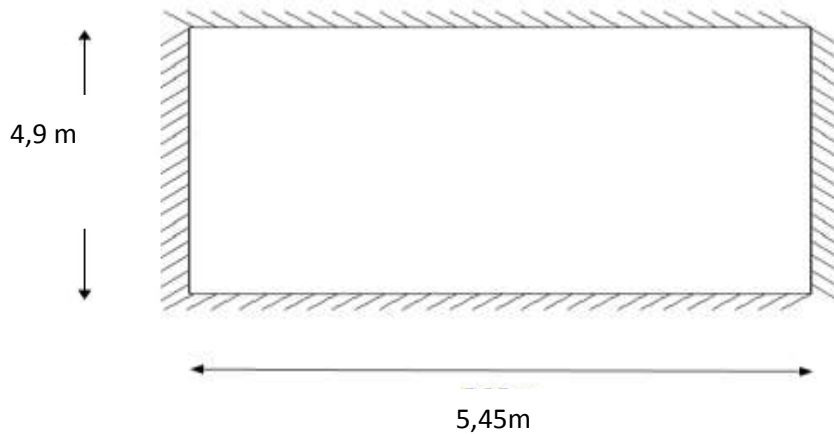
Dimensions d'une dalle pleine rectangulaire.
